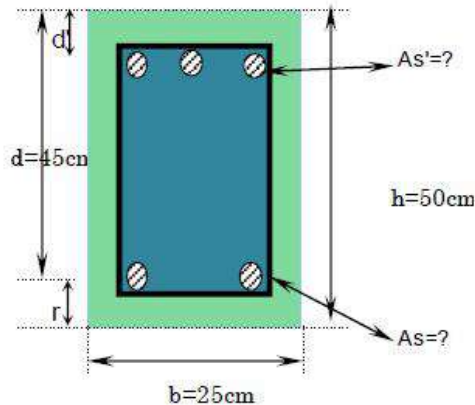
Pre dimensionamiento de viga 0.25x0.50 m
